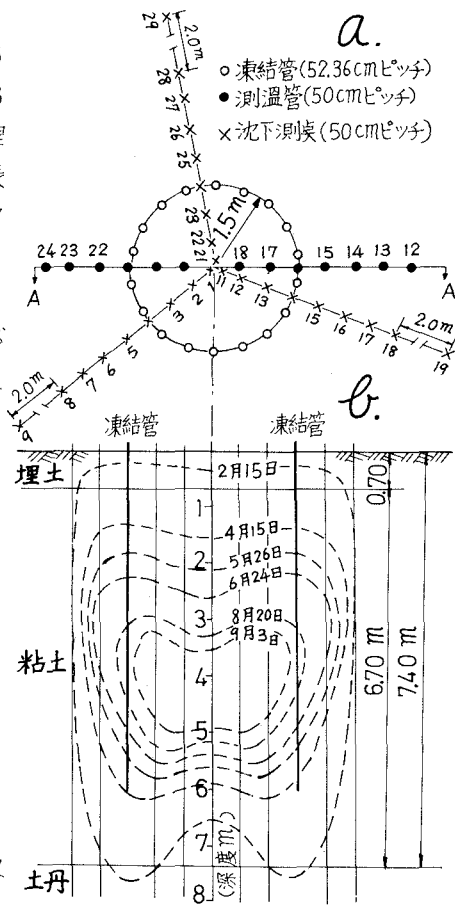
凍結管、測温管および沈下測定の配置平面図(a), a.図のA~A断面図, および土層図(b)
